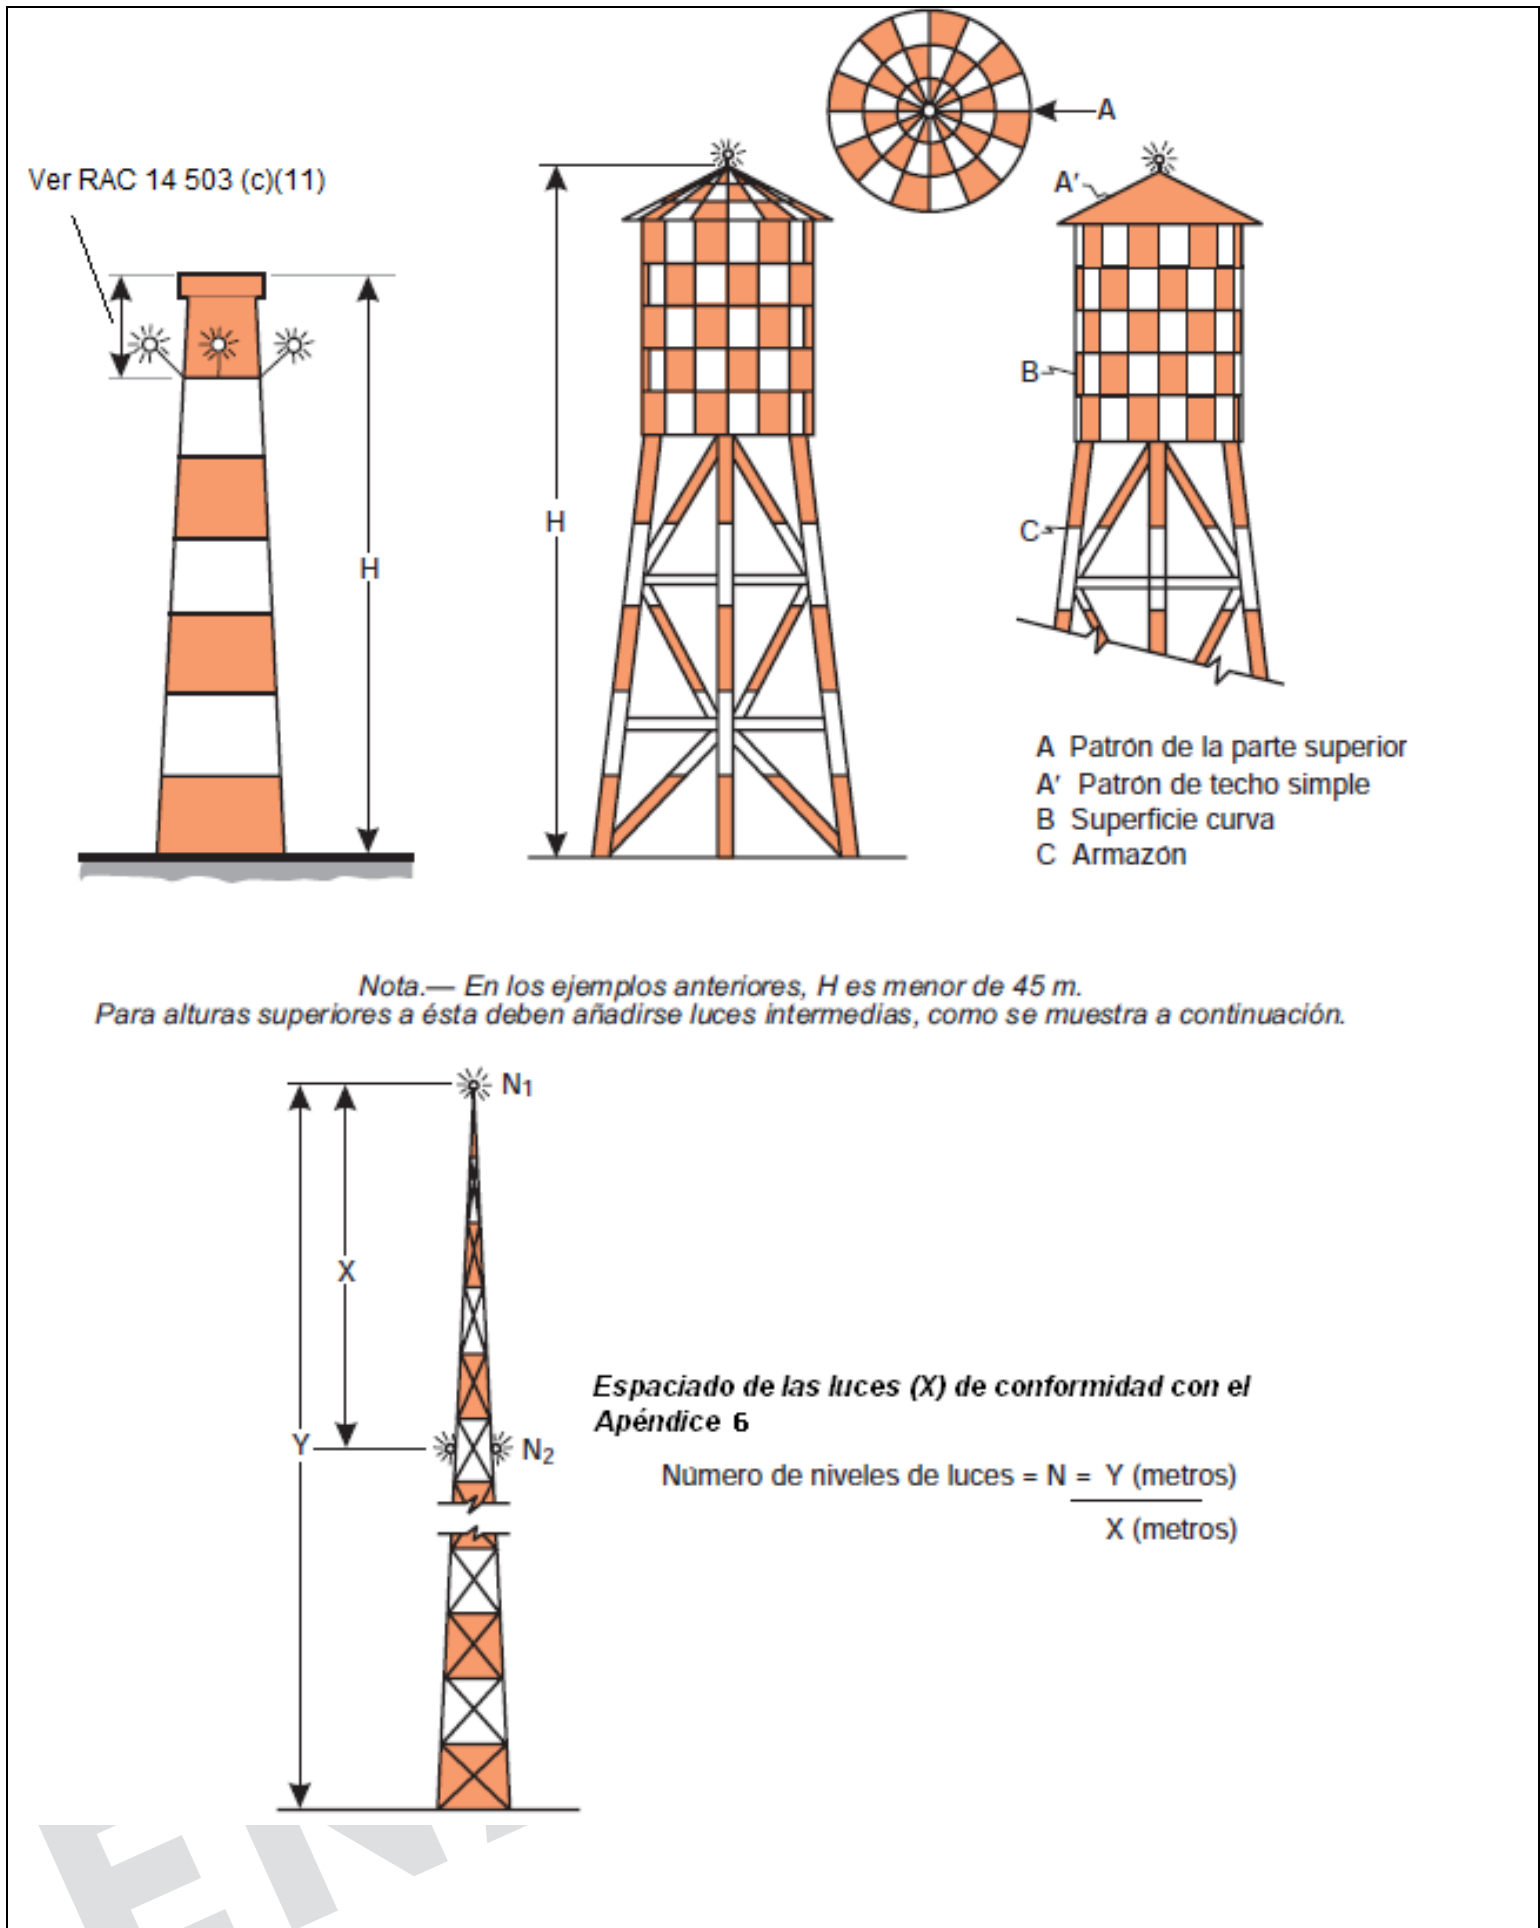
Ejemplos de señalamiento e iluminación de estructuras elevadas
